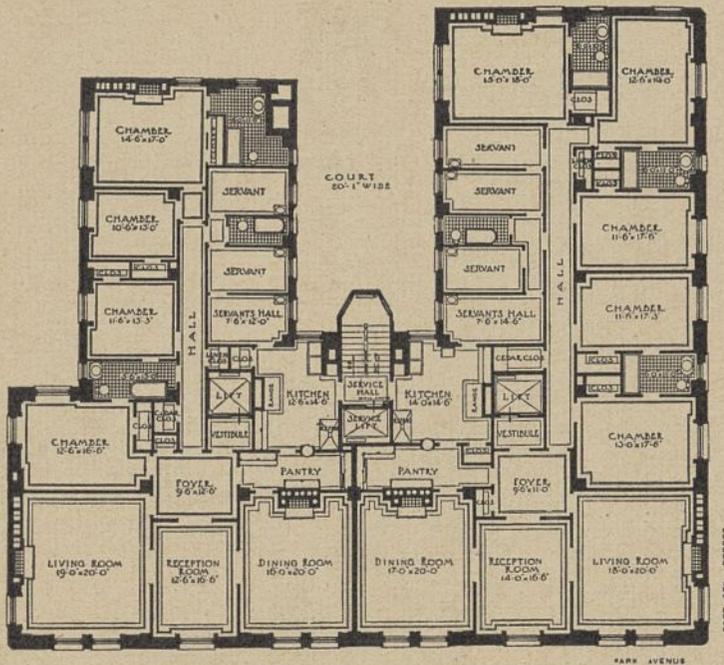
Miethaus New York, Park Avenue. 12 Geschosse. Der Grundriß zeigt eine Wohnung mit 11 Zimmern, 3 Bädern und 3 Dienerkammern und eine Wohnung mit 13 Zimmern, 4 Bädern und 4 Dienerkammern.
